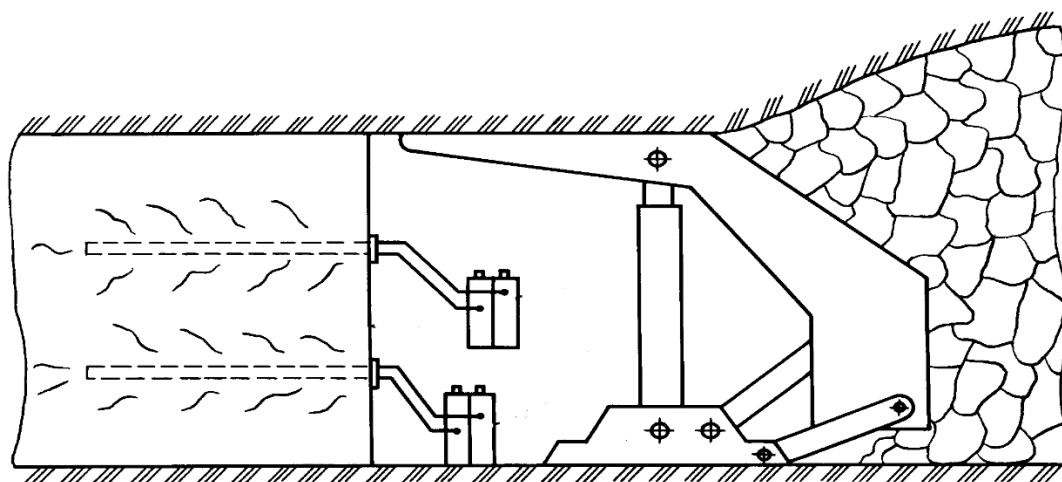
Схема крепления кровли с использованием нагнетаемого раствора [21]
